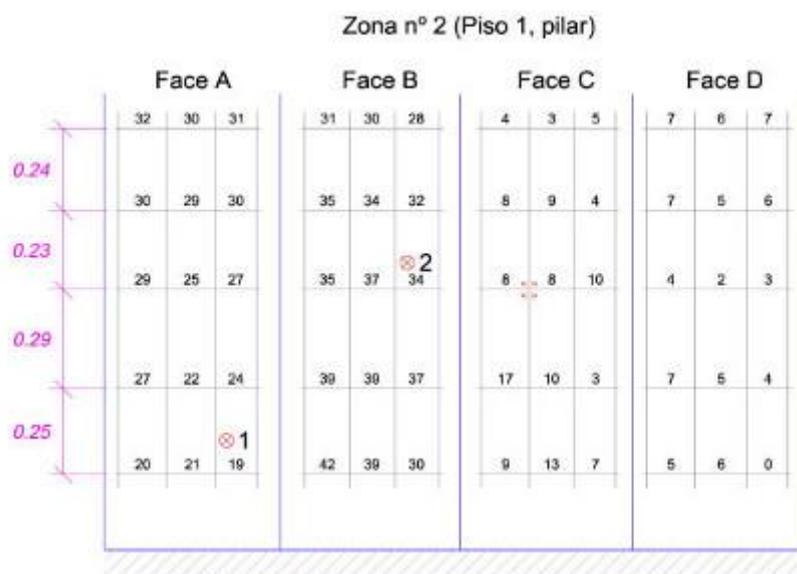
Representação esquemática da disposição das malhas de armaduras num pilar, detectadas com o pacômetro, com indicação dos valores de cobertura.
